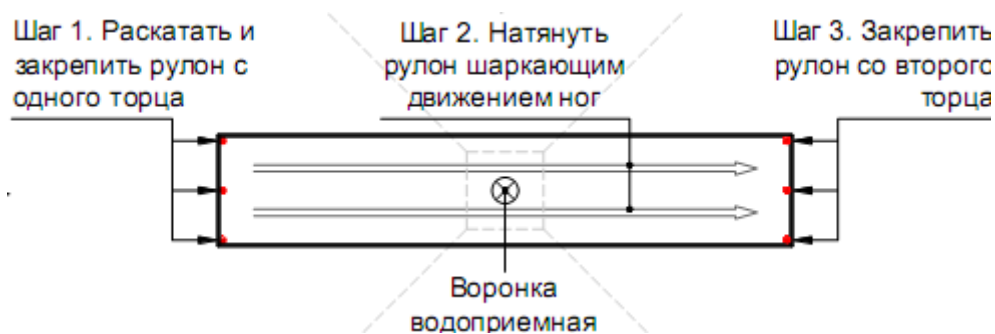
Укладка первого рулона гидроизоляционного материала
